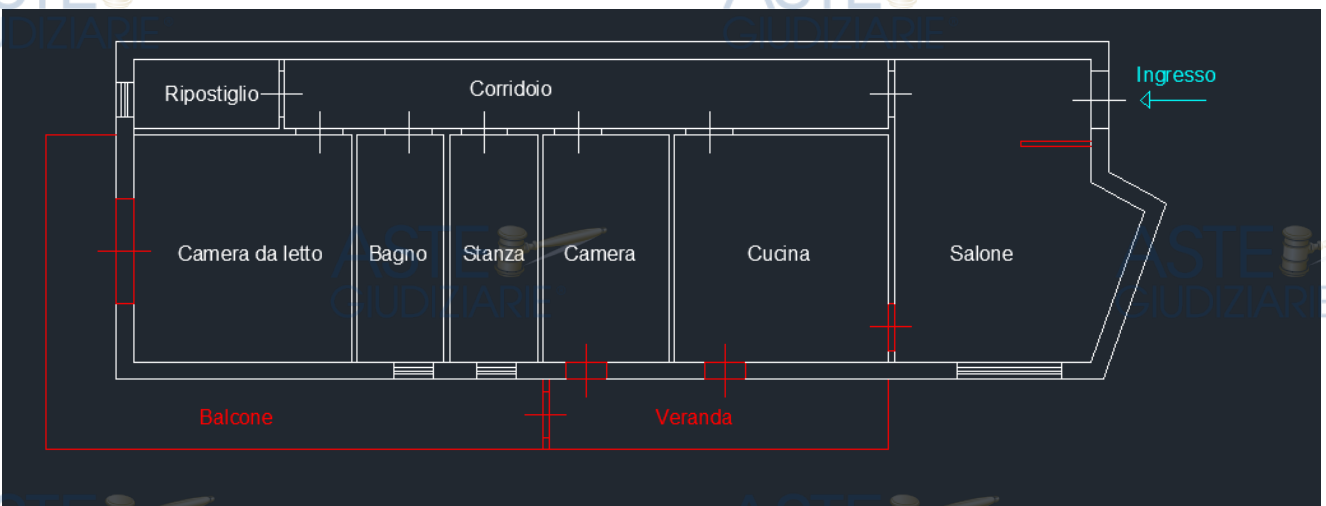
Planimetria allo stato di fatto (a seguito di sopralluogo)
